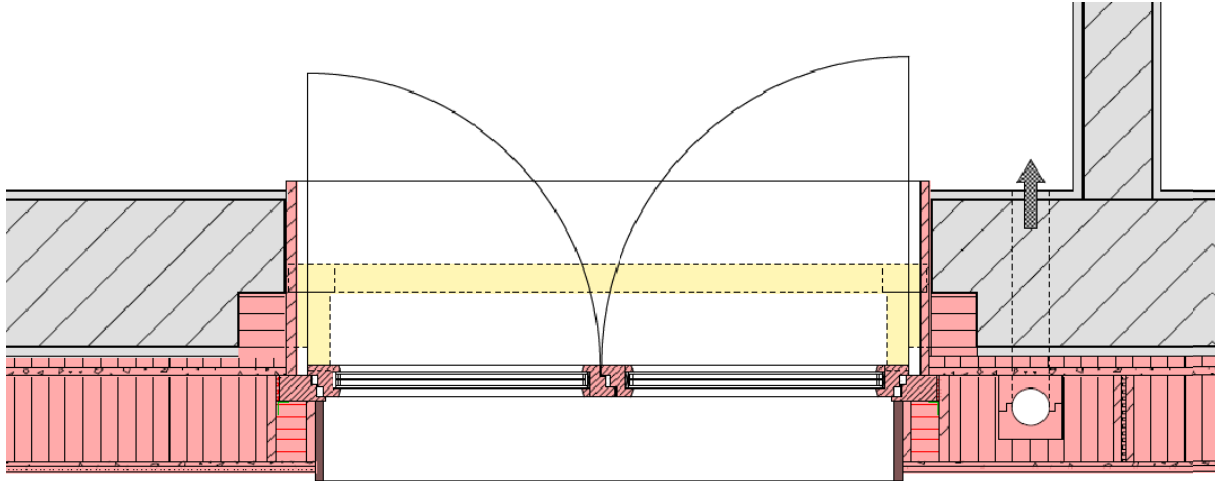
Detailplan Fenster Typ 2, gelb Abbruch bestehendes Fenster. Das neue Fenster ist gleich gross wie das bestehende.
